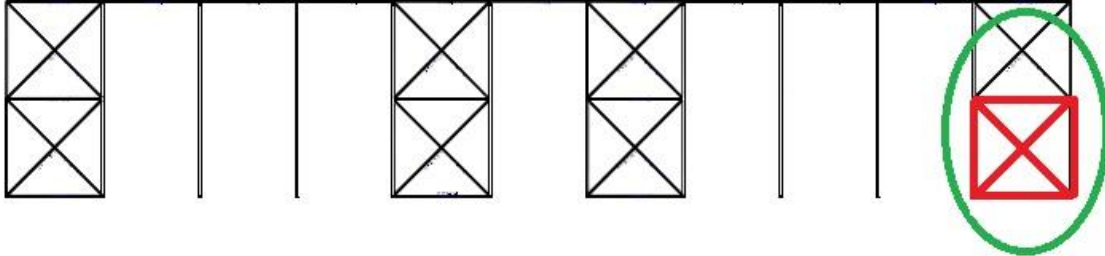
Cubierta con sistema de arriostramiento resaltado
